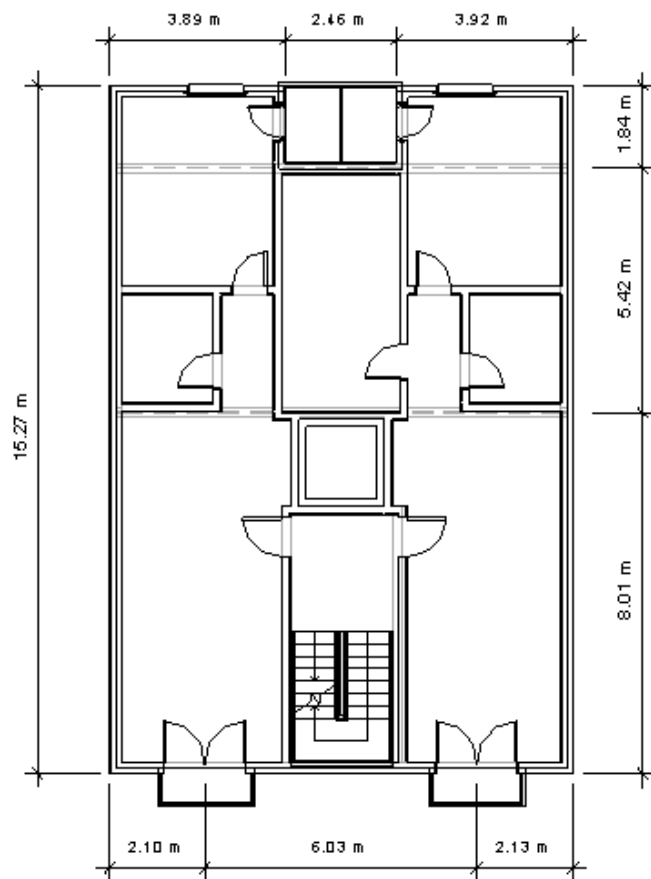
Plano de planta tipo del edificio de paneles de madera contralaminada (Fuente: elaboración propia)
